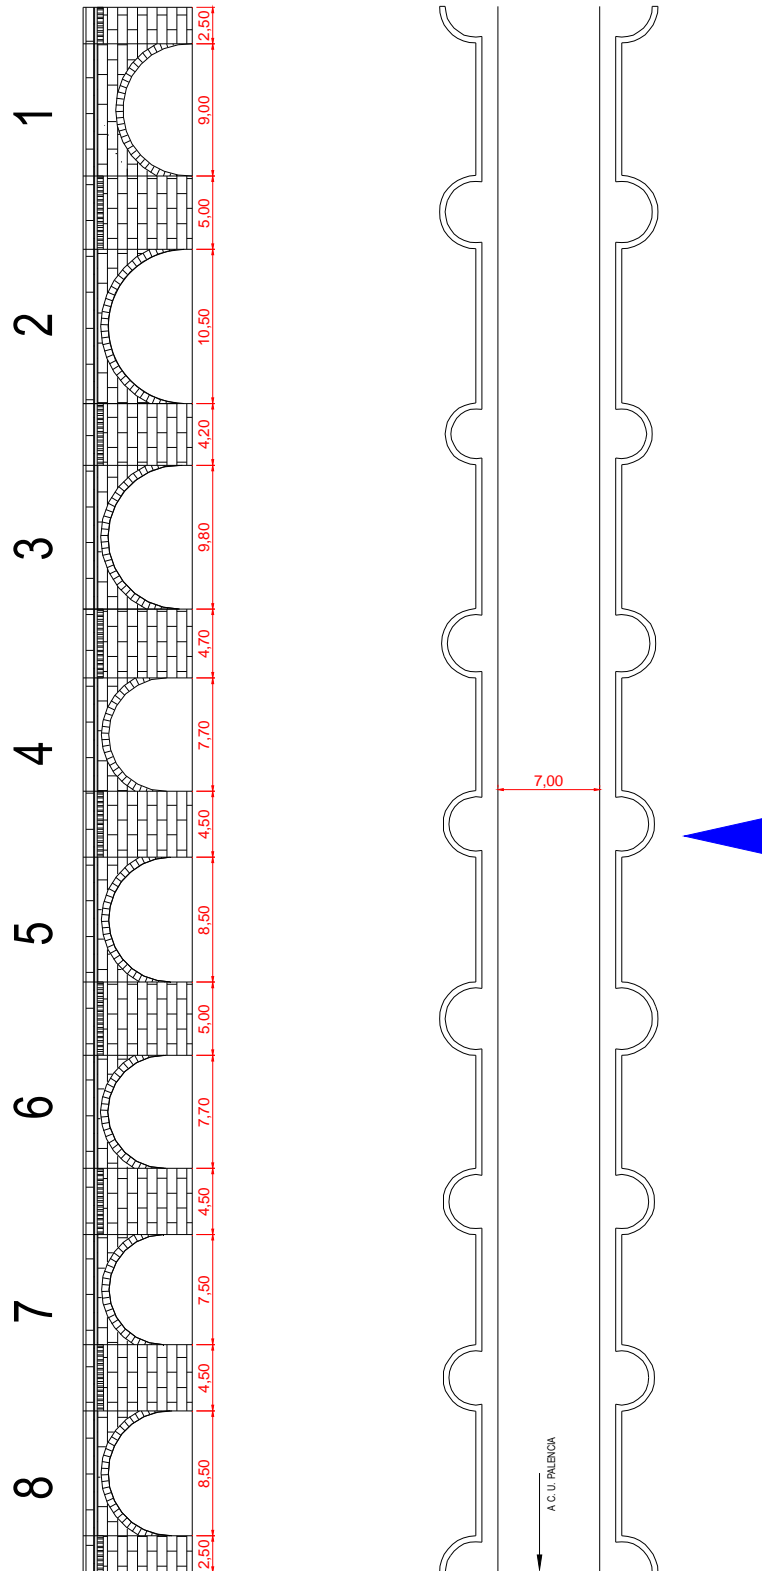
Planta y alzado de aguas arriba del puente Mayor
